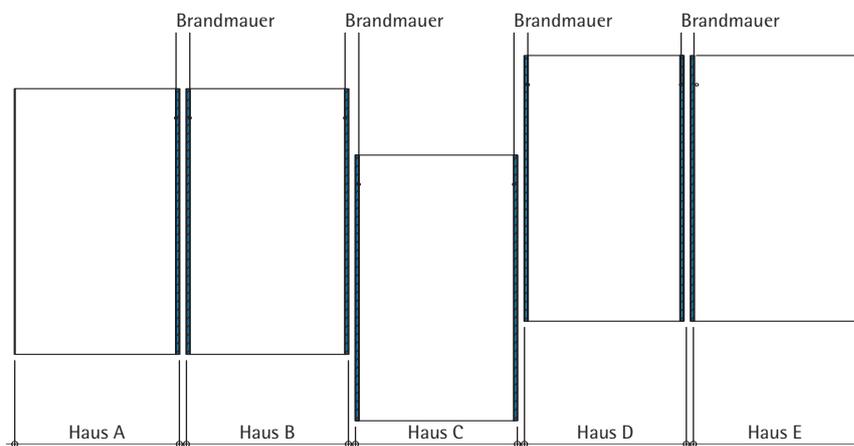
Mögliche Gebäudeanordnung im Grundriss
